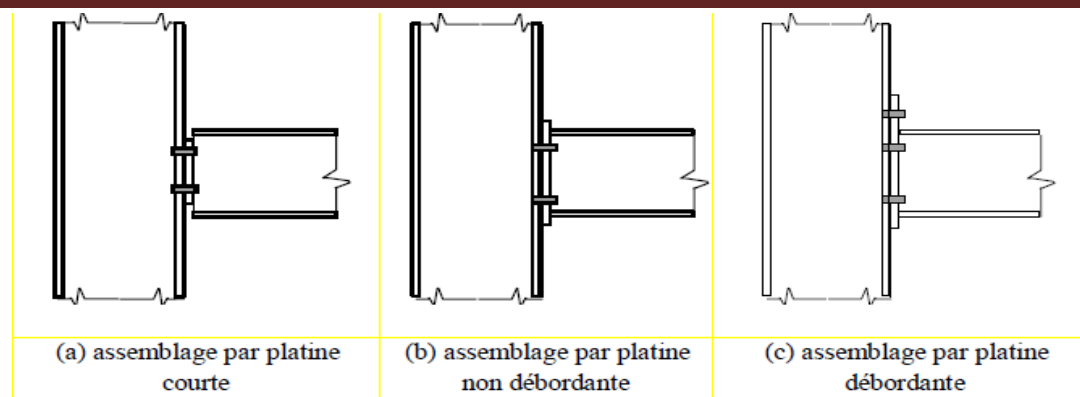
Assemblage poteau poutre par platine d'extrémité boulonnée
